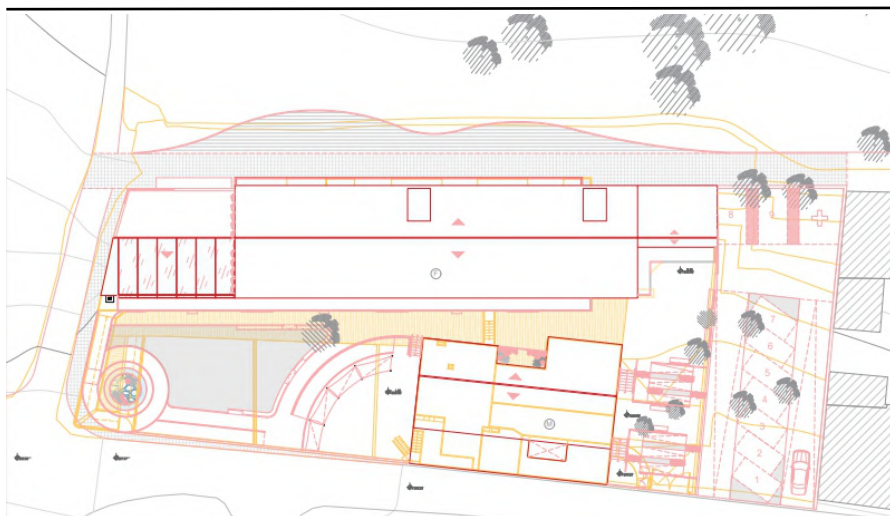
Proposta de alteração da planta de cobertura do conjunto.
